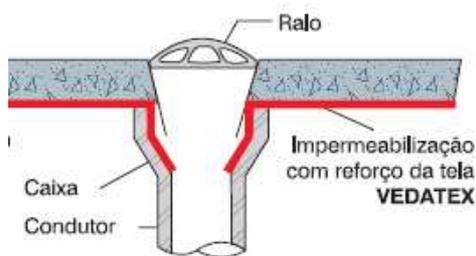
Detalhe da impermeabilização e grelha dos ralos
